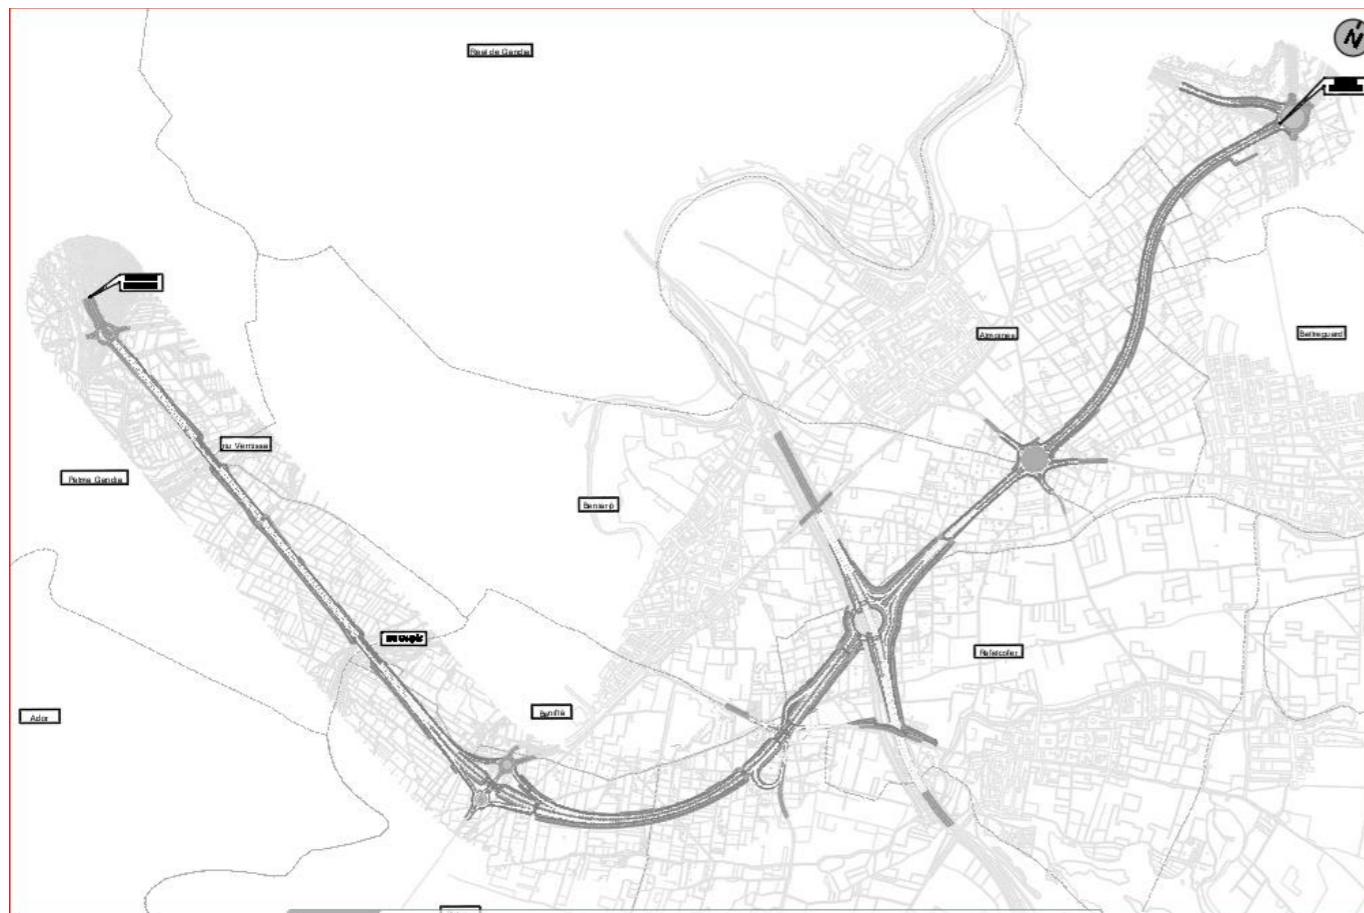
Trazado proyectado. Fuente: Elaboración propia.
